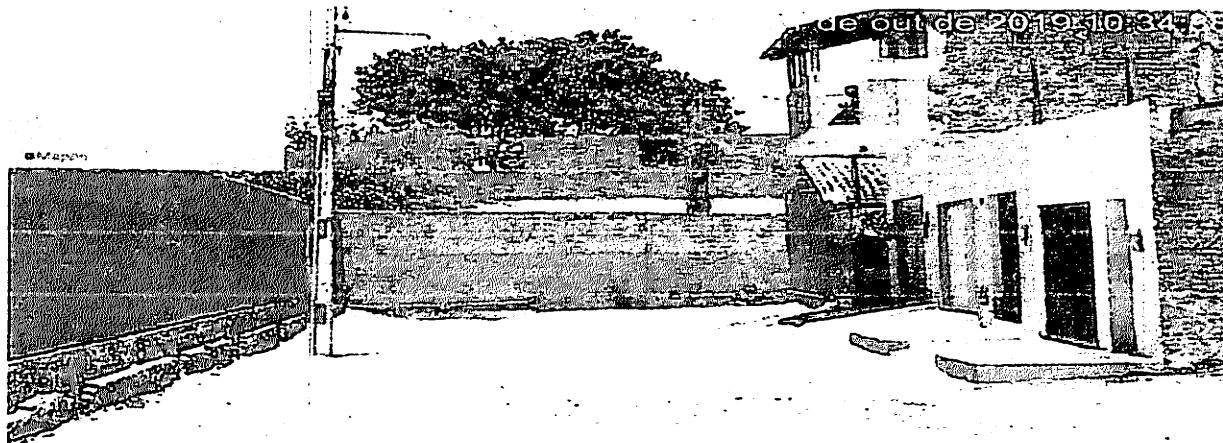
(Rua Projetada 02 - Vila da Papa)
